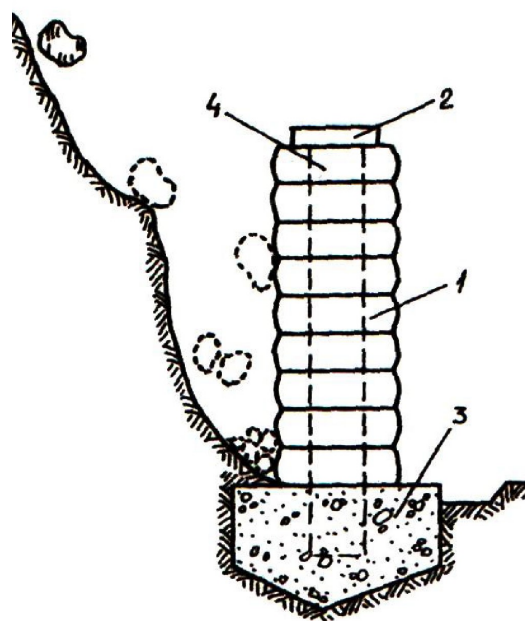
Каменевловлювальна підпірна стінка: 1 - автомобільні покришки; 2 - насадка; 3 - бетонний фундамент; 4 - стовп
